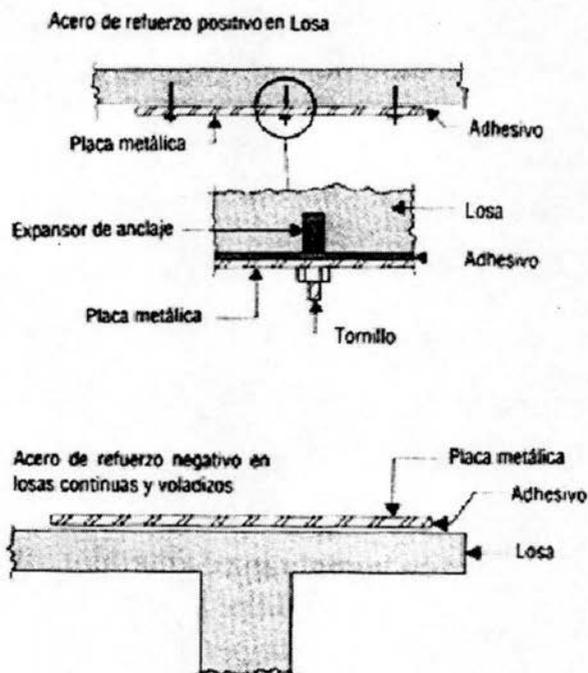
Reparación con Placas metálicas adheridas con resina epóxica
